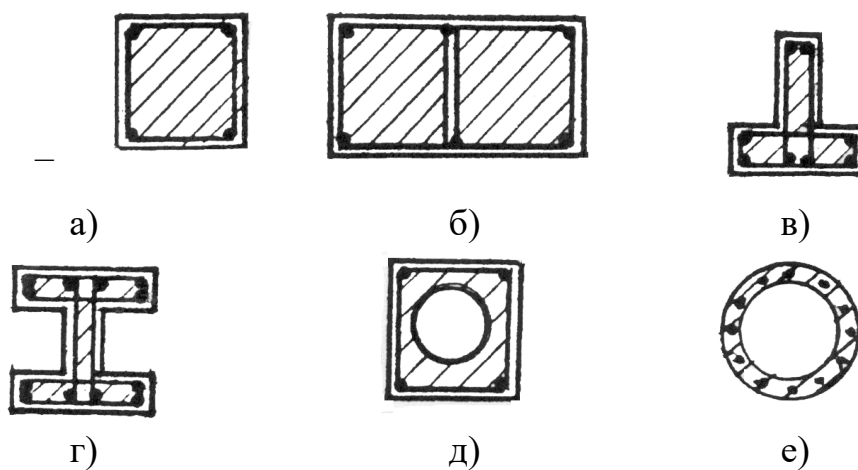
Форми поперечних перерізів залізобетонних палі: а – квадратний, б – прямокутний, в – тавровий, г – двотавровий, д – квадратний з порожниною, е – круглий
